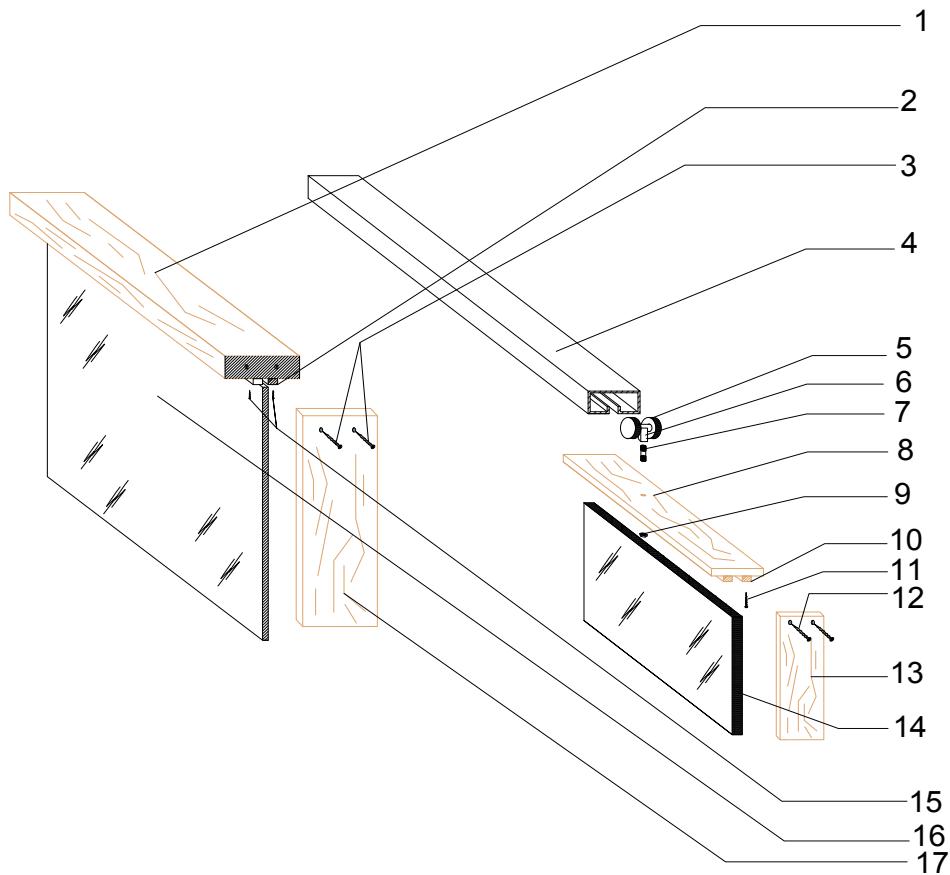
Detalle puertas de vidrio. Romero, (2018).
